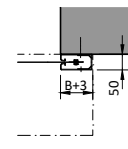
DETAIL DER MONTAGE VON FÜHRUNGSSCHIENEN
